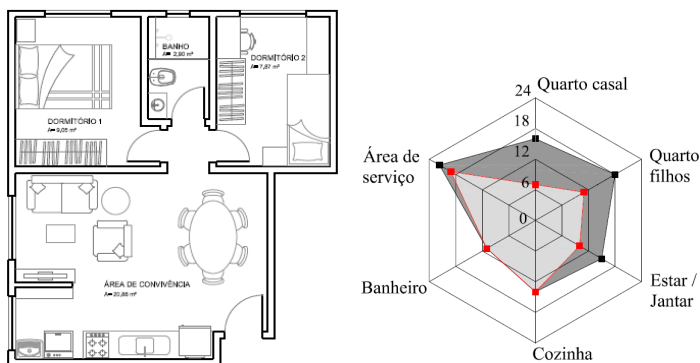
a) Planta baixa Tipo B. b) Modelo radar Tipo B com modificações.
